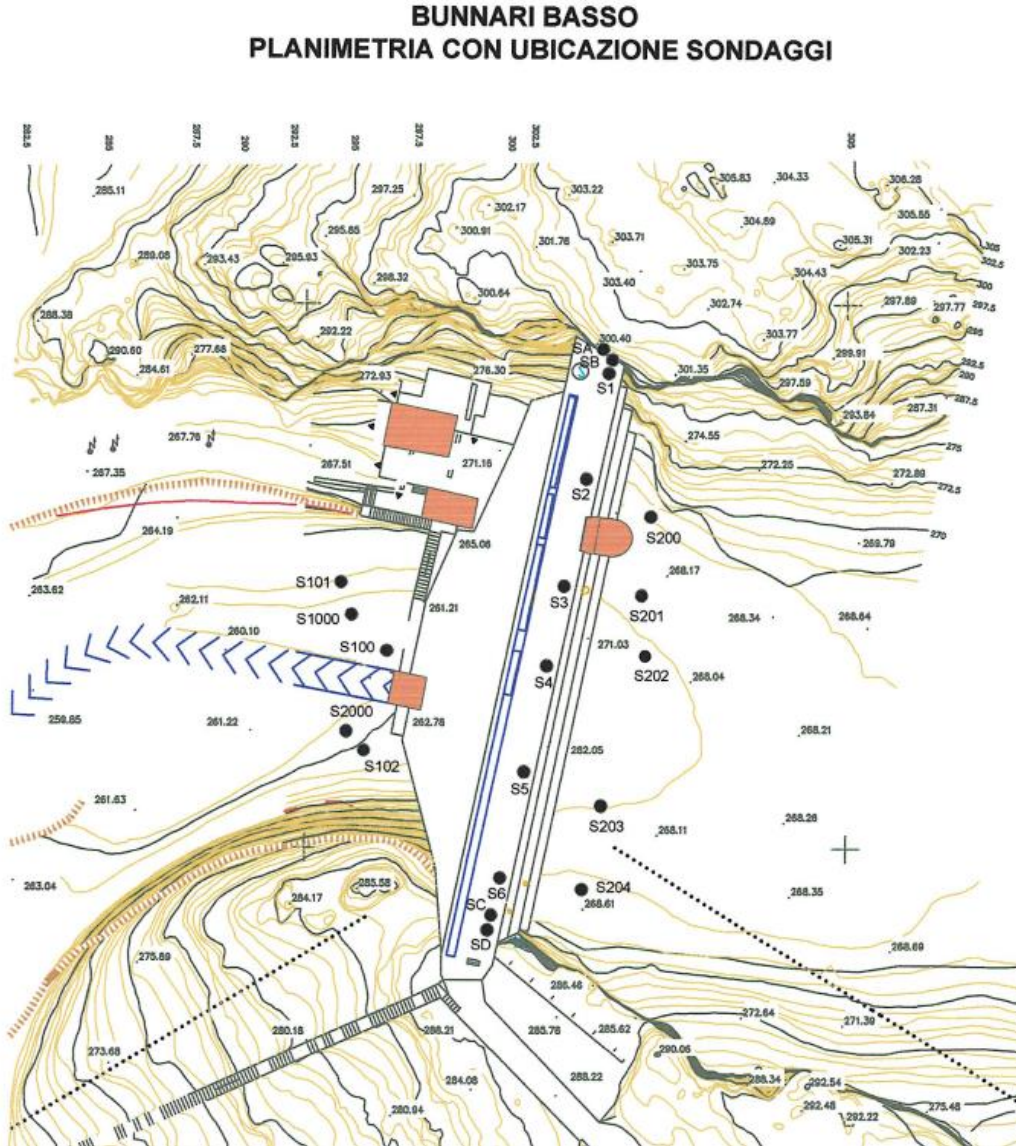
Planimetria con ubicazione dei sondaggi eseguiti in zona diga Bunnari Basso
